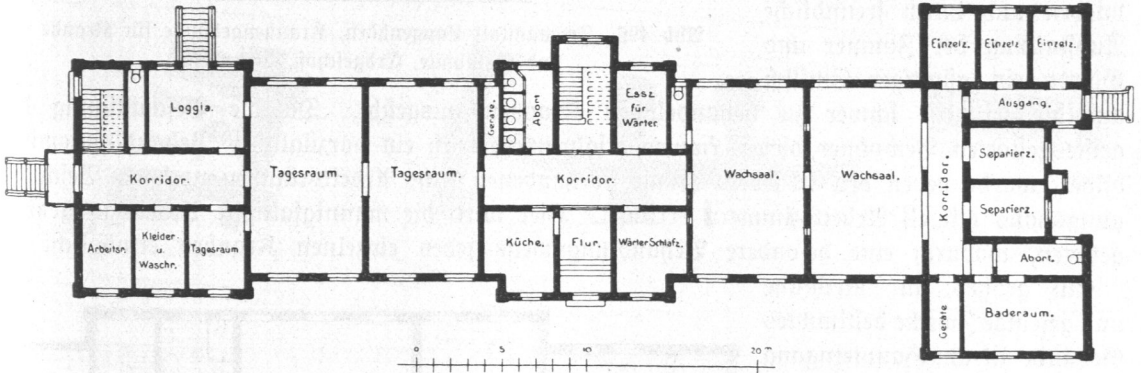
Irrenanstalt Langenhorn, Überwachungshaus für 50 Männer und 8 Wärter, Erdgeschoß, Grundriß.
